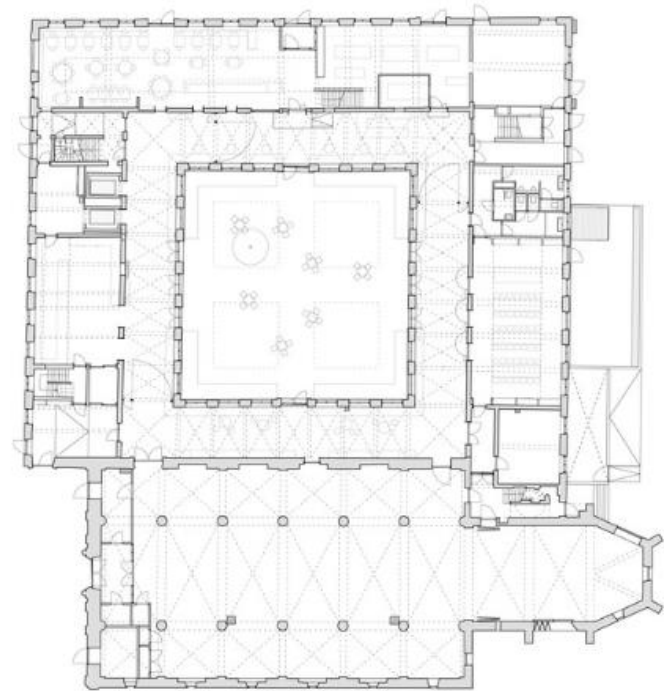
Planta baja, Biblioteca Municipal Het Predikheren.
